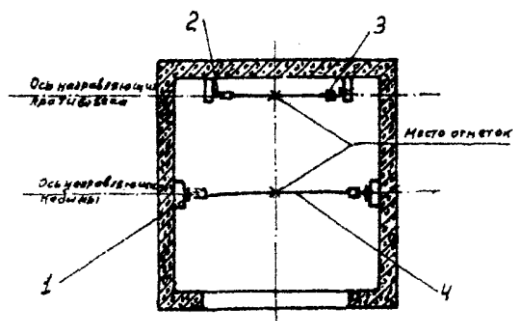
Установка осевых струн для выверки лебедок (противовес сзади кабины):
